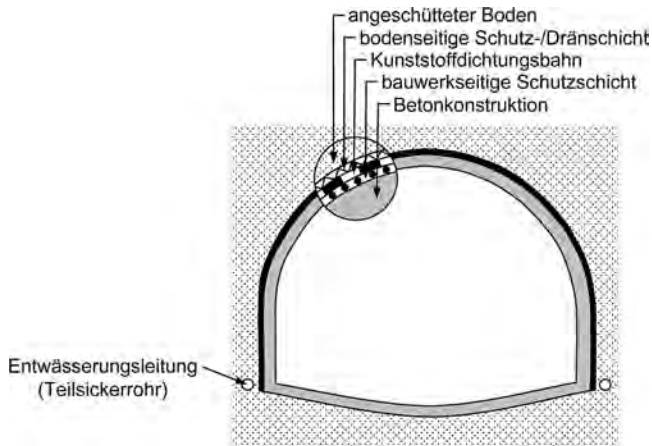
Aufbau eines Dichtungssystems im Gewölbequerschnitt (offene Bauweise, Regenschirmabdichtung).
